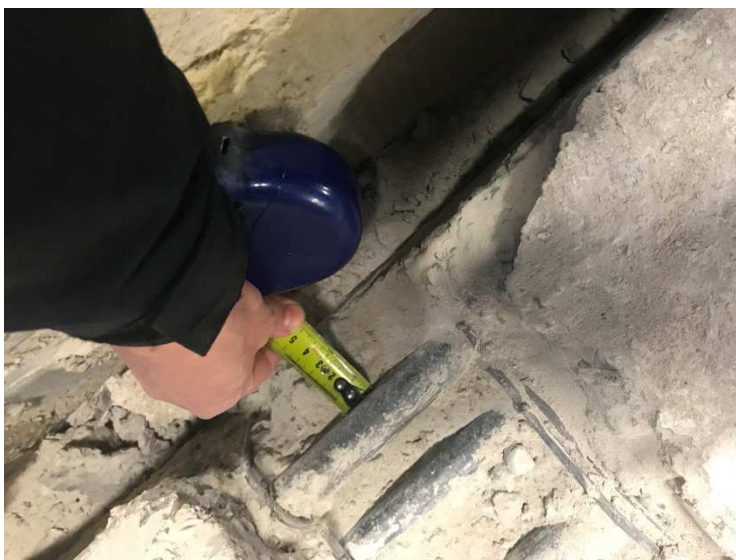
Stalowa konstrukcja wsporcza podtrzymująca strop Akermana
